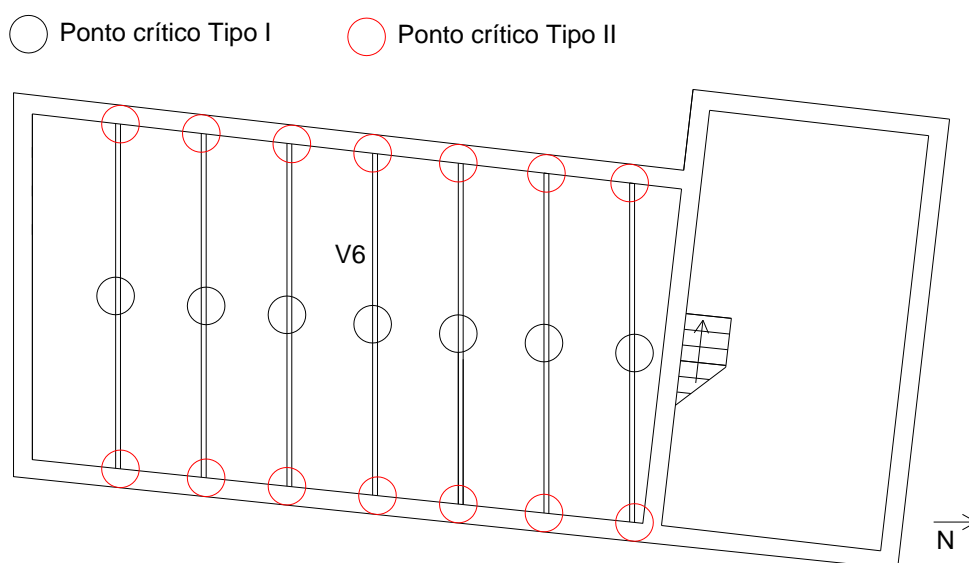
Pontos críticos dos elementos estruturais de madeira do pavimento das águas-furtadas
